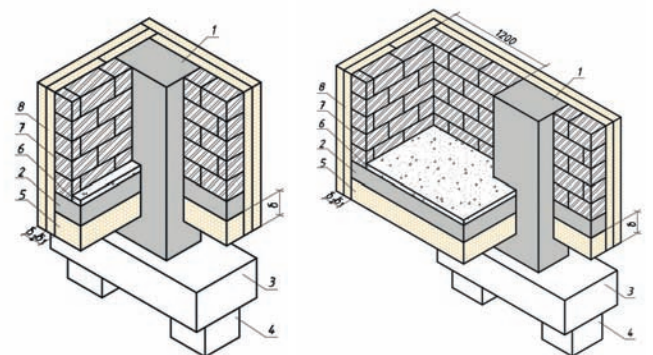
Угловое соединение наружной стены и цокольного перекрытия с наружной теплоизоляцией
